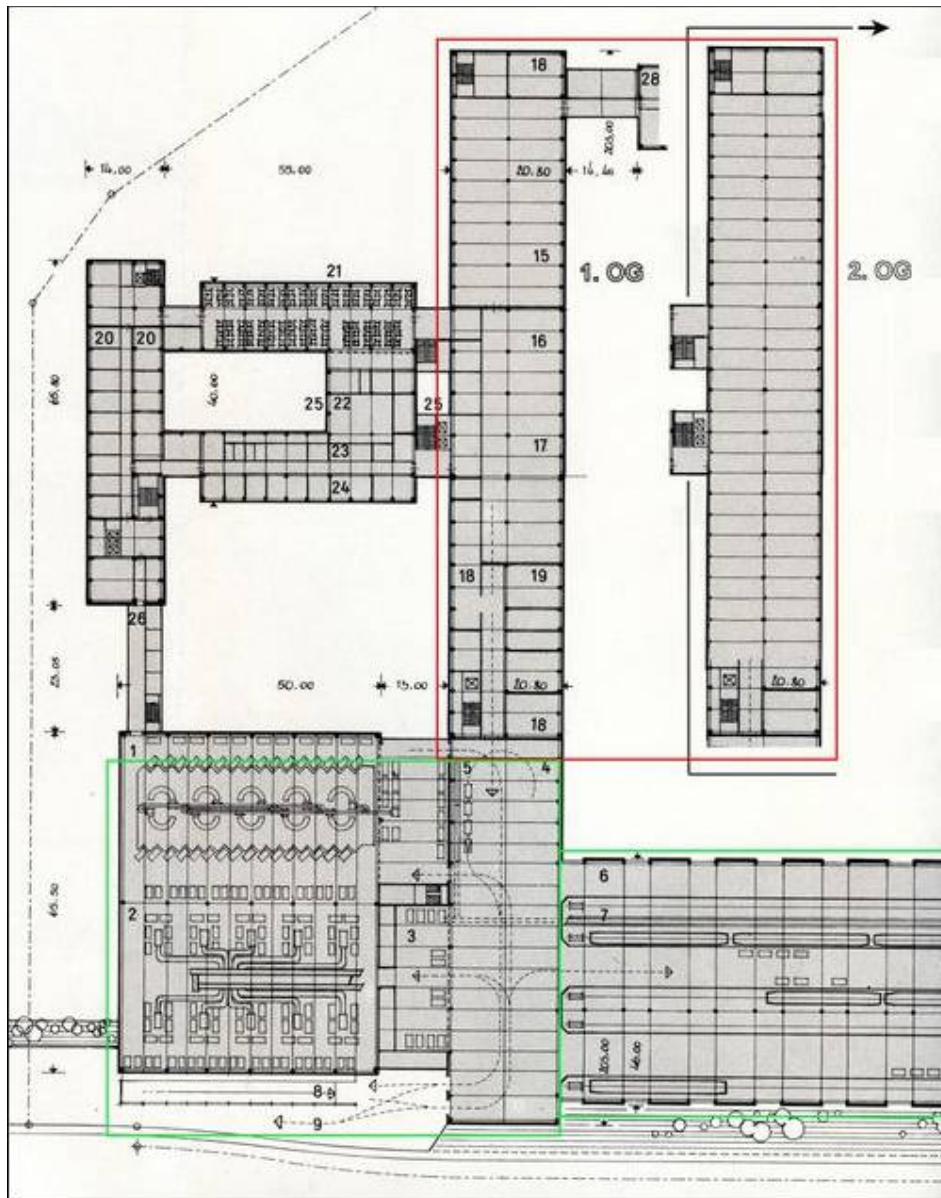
Modifizierter Planungsgrundriß 2. Bauabschnitt 1. und 2. Obergeschoß Betriebsgebäude
